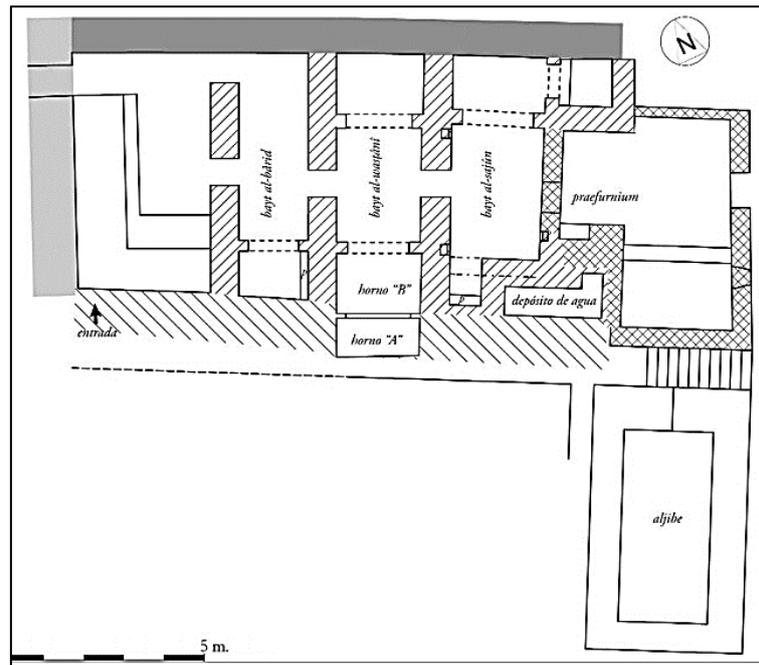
Plan du bain de la tropa. Source GILOTTE³¹⁷
